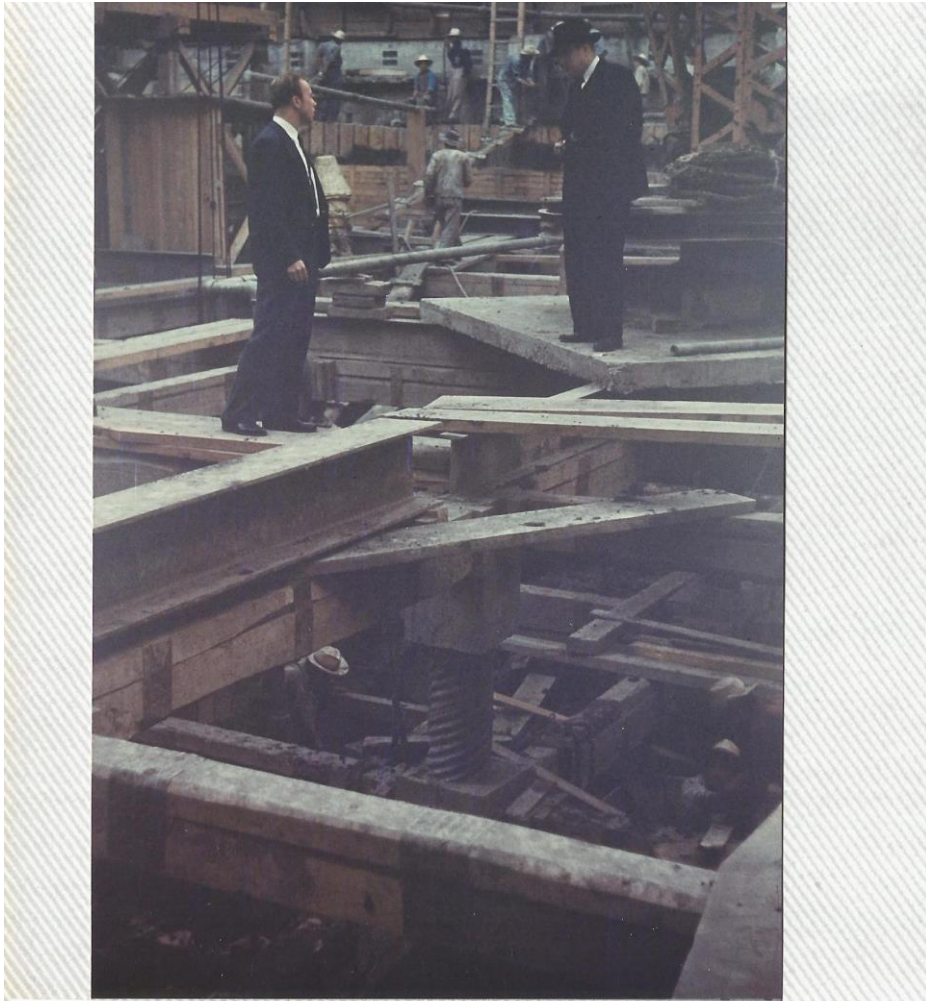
PILOTES APOYO DEL CONTRAVENTE DE MUROS DE CIMENTACIÓN.
